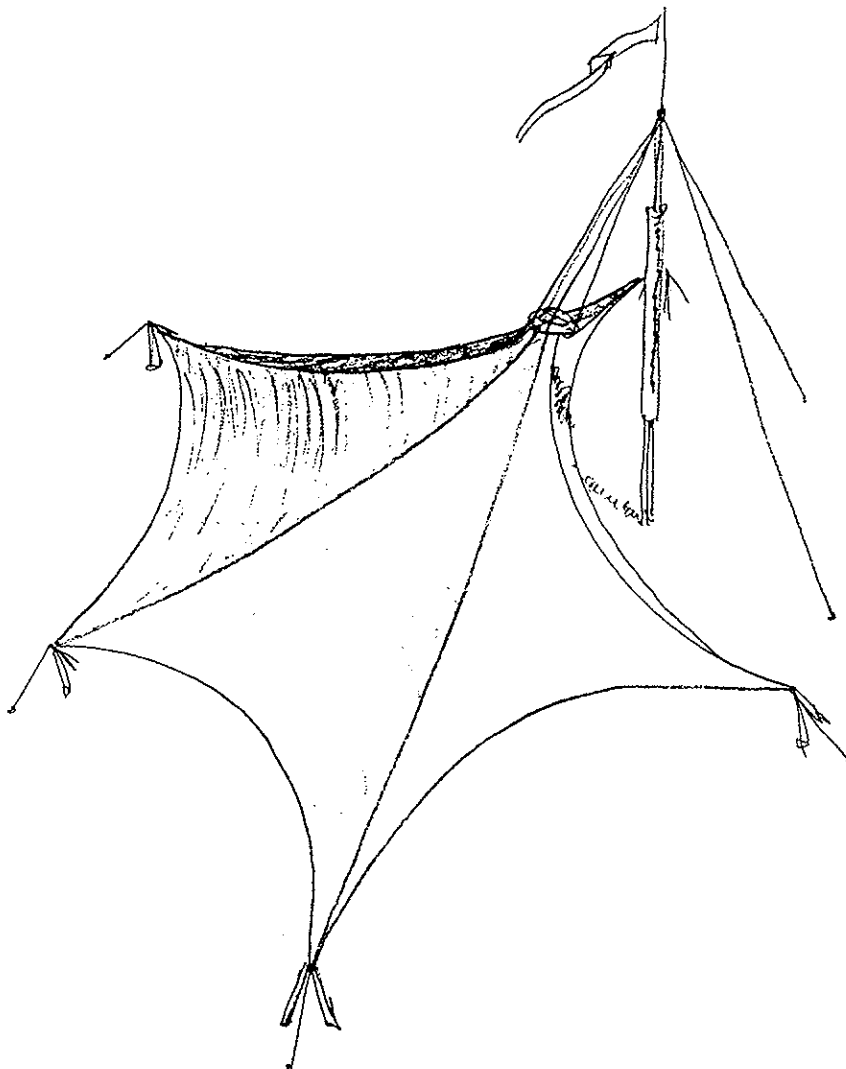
Cubierta tensada, apuntalada. Puerta de acceso a la EXPO'75, de Okinawa.
